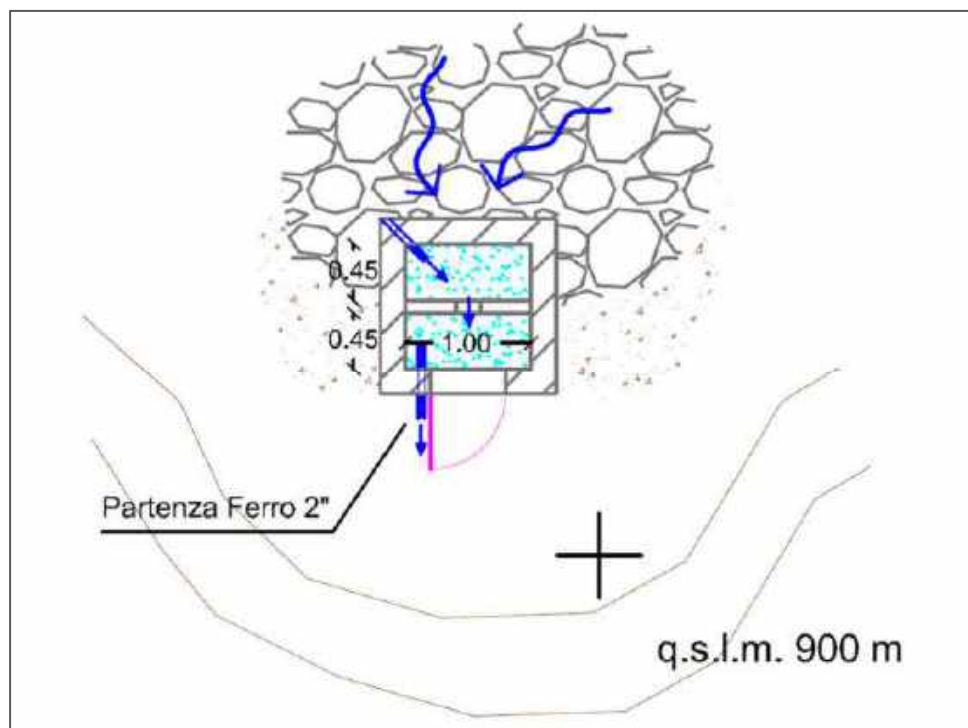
Pianta Sorgente 1 e 2 Le Polle
